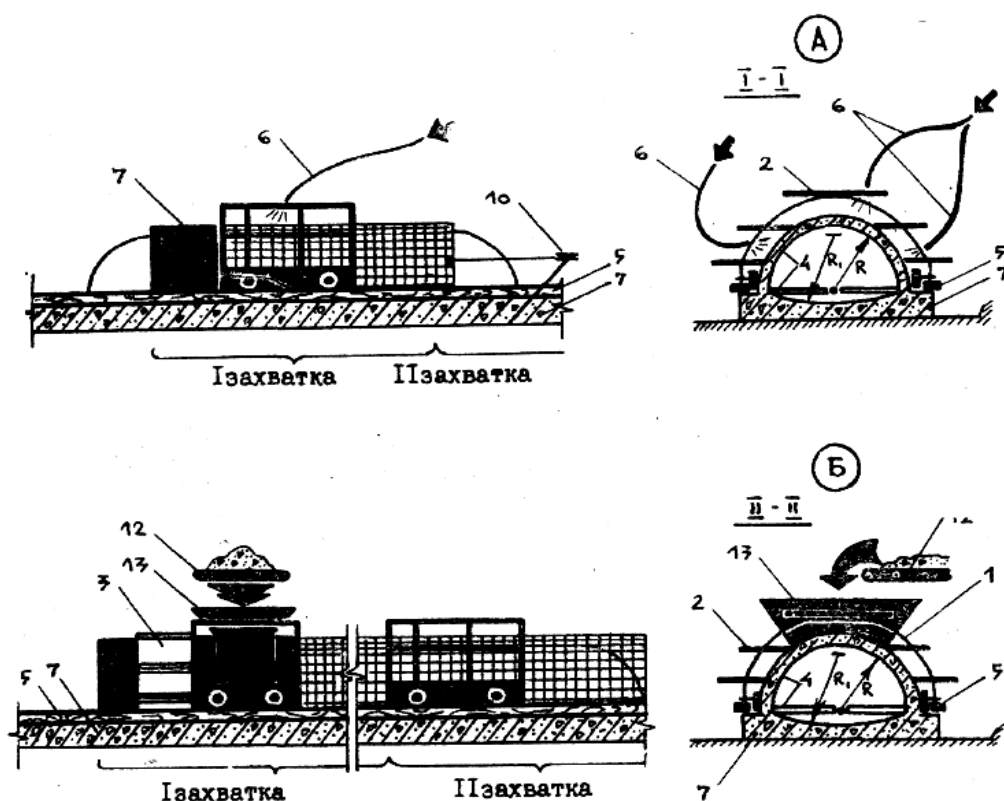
Схема бетонирования на несъемную опалубку:
